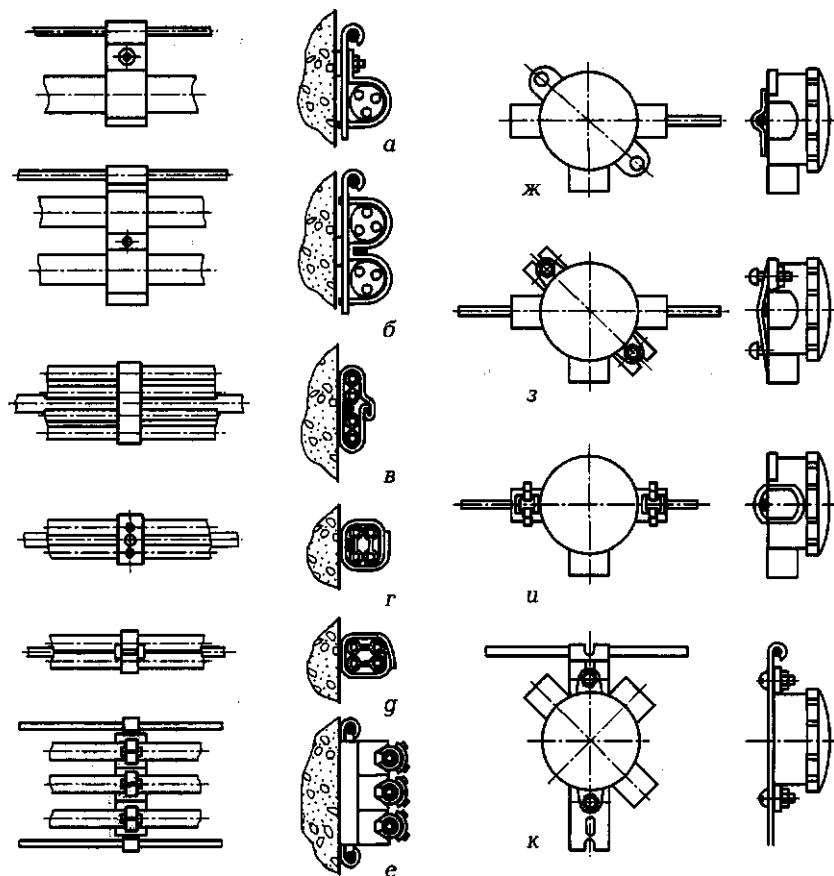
Прокладка кабеля и проводов по стене с креплением к струнам:
